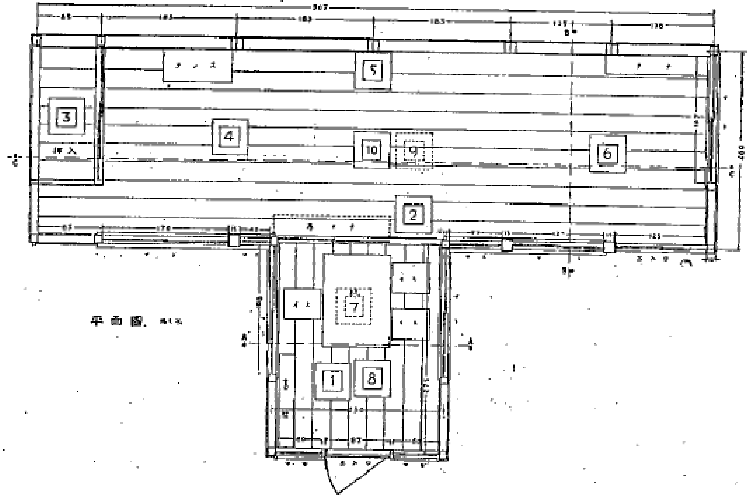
平面図 (□は熱電対位置、1～6 : 床上 1.35m、7, 9 : 0.02m、8, 10 : 2.35m)
